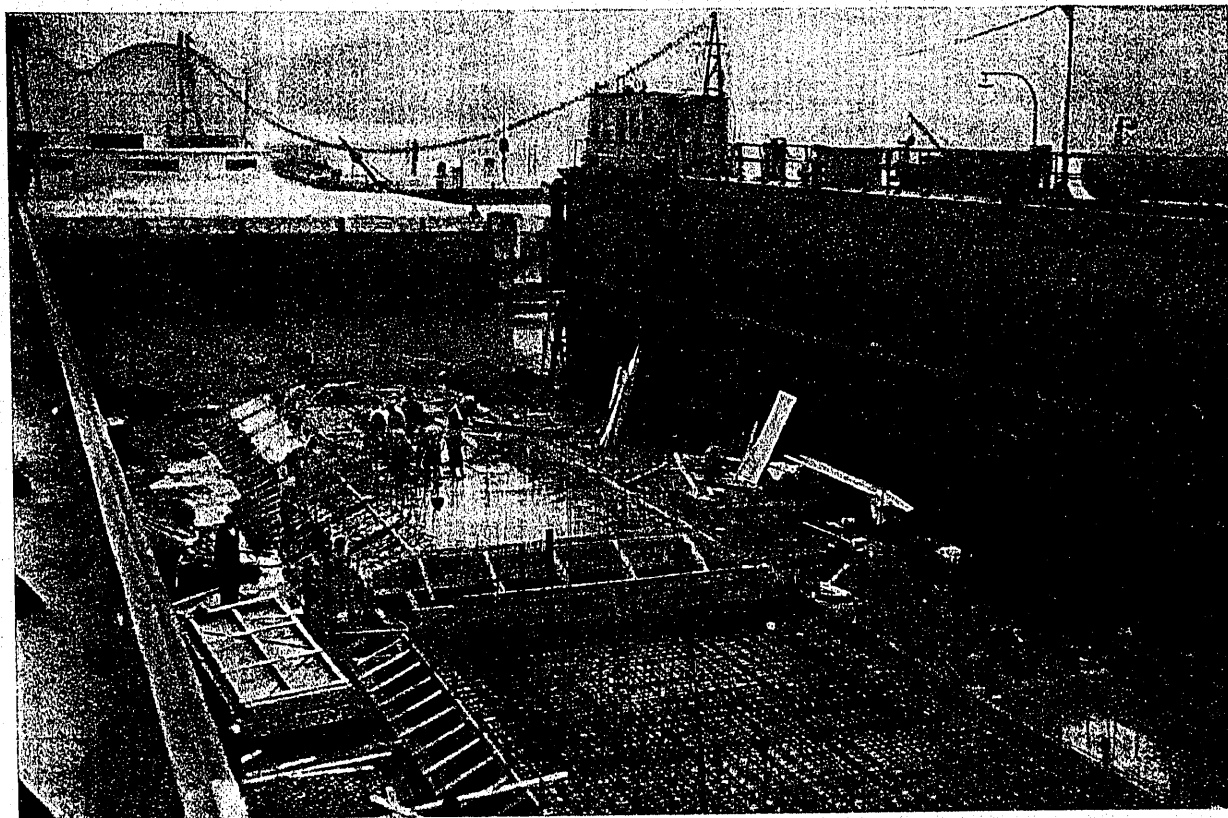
Hormigonado de la solera de los cajones pequeños en un dique flotante.
